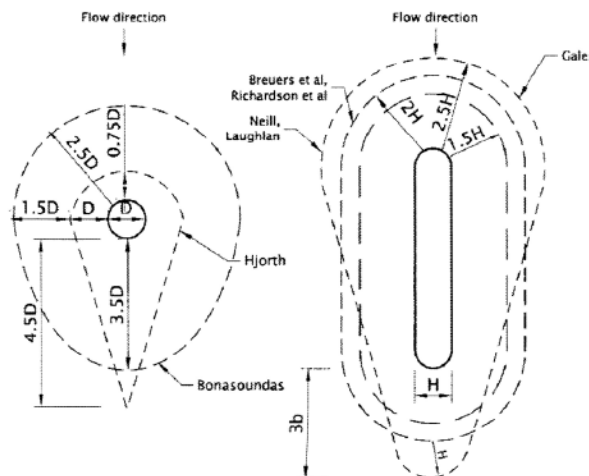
Vista en planta y dimensionamiento de la protección de manto de escollera.<sup>110</sup>
